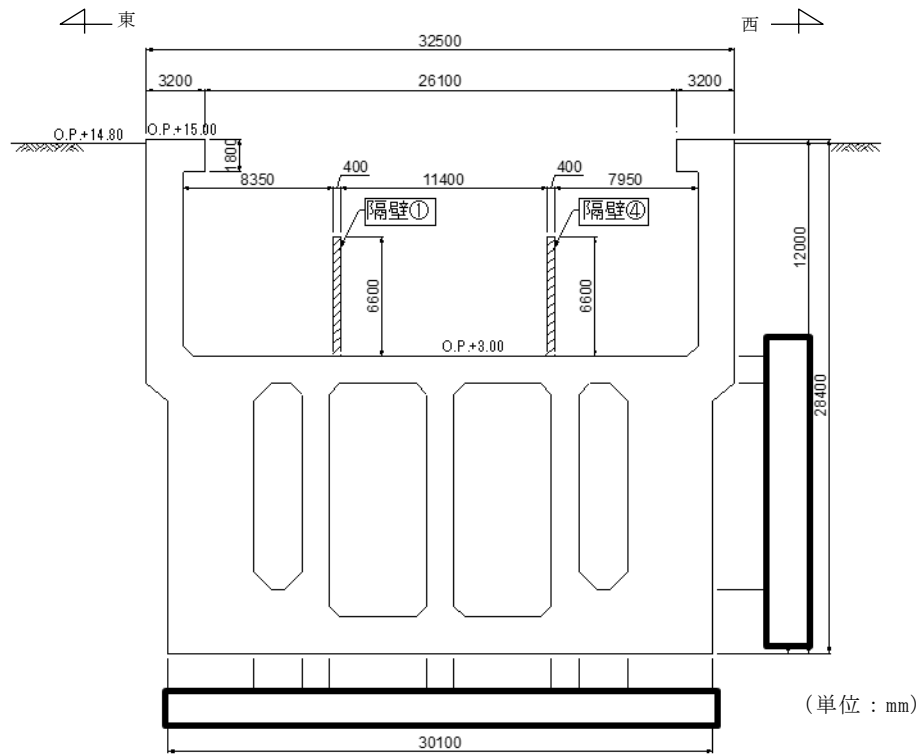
(1) 補機ポンプエリア断面図 (①—①断面)
